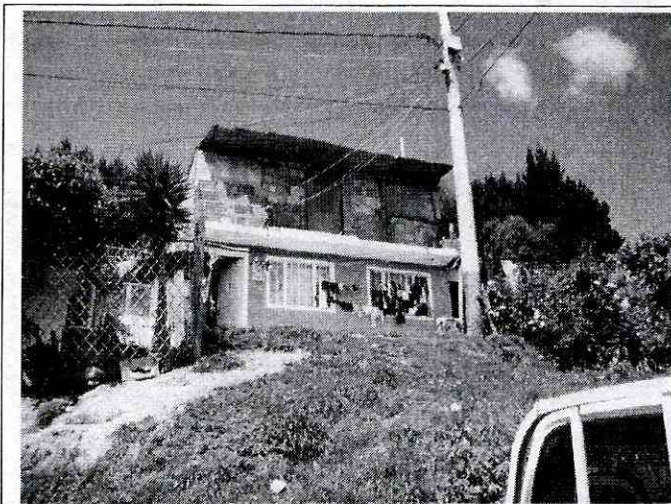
Fachada principal del predio de la Transversal 4 Este # 106-28 Sur.
